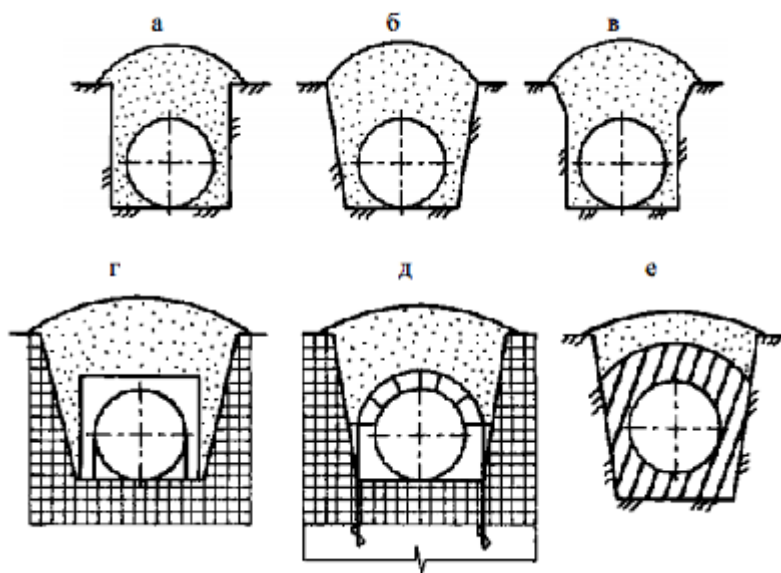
Подземные схемы прокладки трубопровода: а- прямоугольная форма траншеи; б- трапецидальная форма траншеи; в- смешанная форма траншеи; г- укладка с балластировкой седловидными
